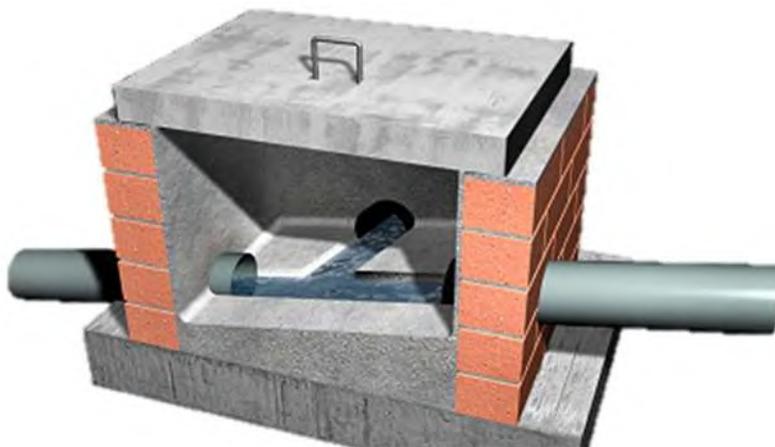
Esquema del tipo de registro elaborado en sitio con plantilla de concreto simple, muro de tabique rojo recocido, aplicado de aplanado pulido con llana metálica, uso de cuña con pendiente no menor al 2% y con tapa de concreto reforzado. Fuente: http://www.mexico.generadordeprecios.info/espacios_urbanos/Instalaciones/Urbanas/Redes_de_saneamiento/Registro_de_mamposteria_de_tabique.html
